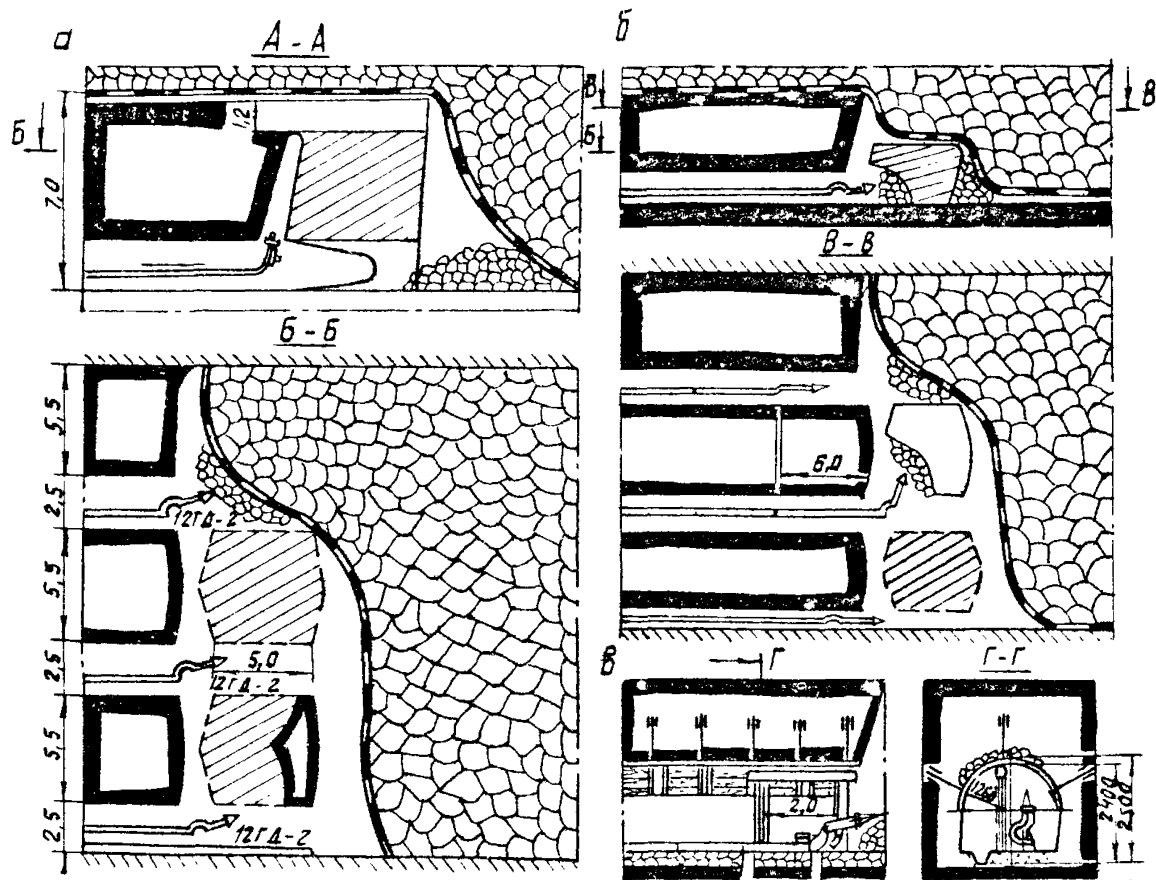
Схема вьезки угля и управления глубоким перекрытием в подэтаже опускаемыми блоками:
